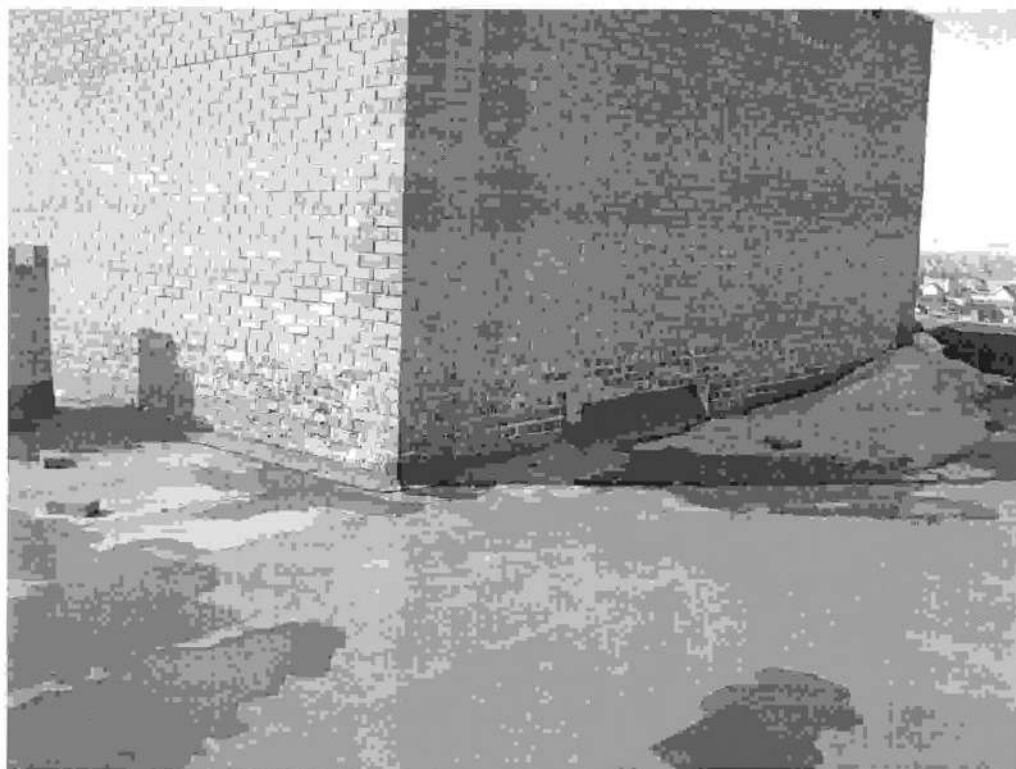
Нарушено примыкание кровли к стенам. Секция 6. Состояние на 01.04.2015г
